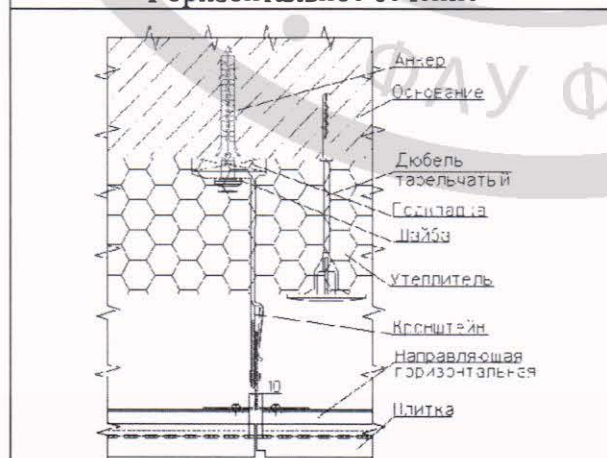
Облицовка - клинкерные и бетонные плитки. Горизонтальное сечение.
